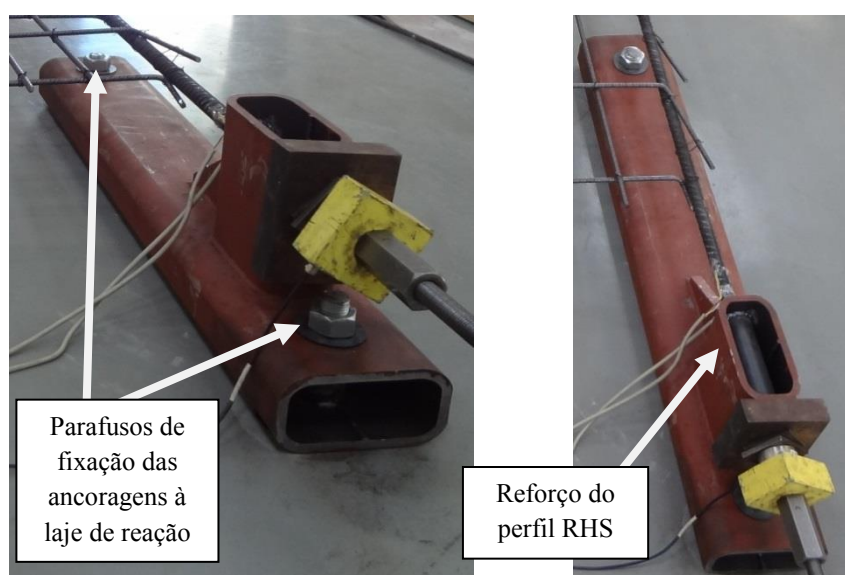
Dispositivos de ancoragem dos varões à laje de reação e reforços.
